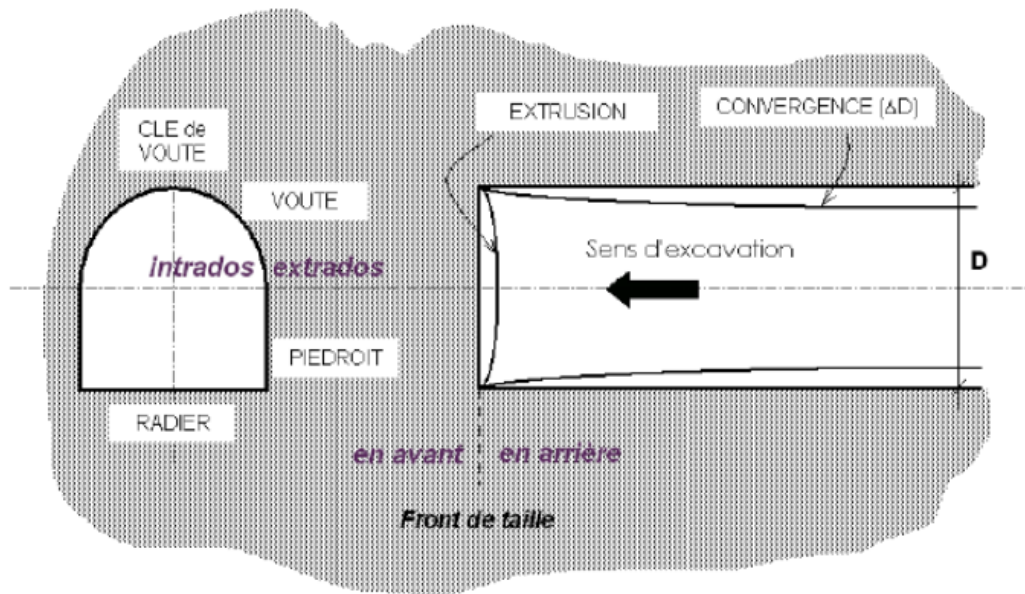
Coupe transversale et longitudinale d'un tunnel au voisinage du front de taille
